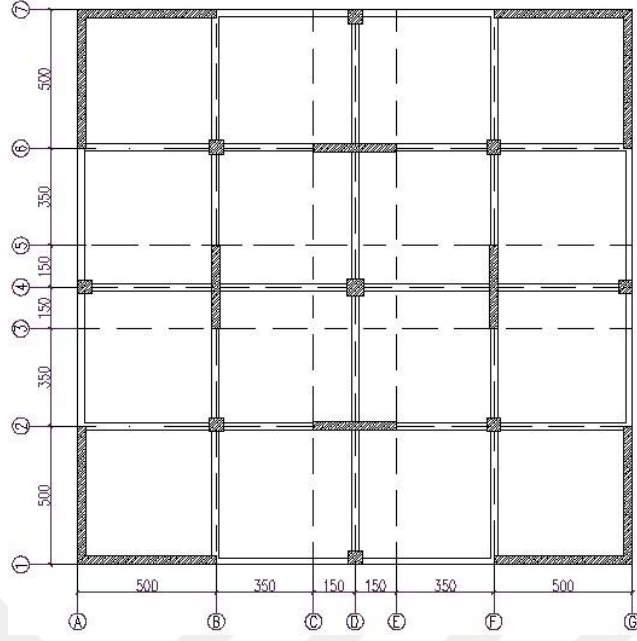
BBP-5 ve BAP-5'e ait kat planı
